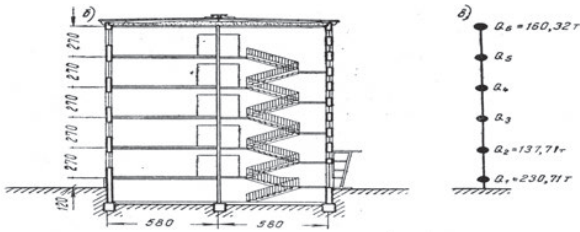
Разрез 5-этажного крупнопанельного дома и его консольная модель: вес перекрытий и стен сосредоточен в уровнях перекрытий [2]
